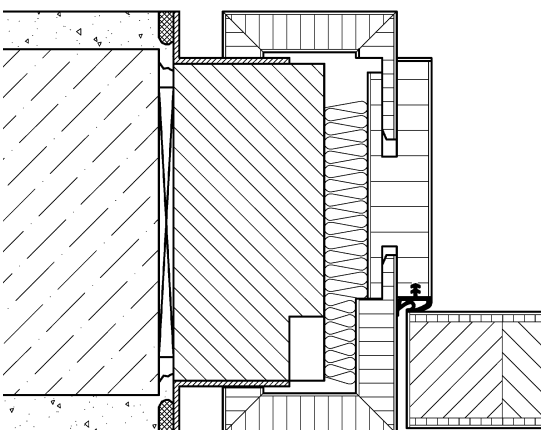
Block-Zarge B60/75 mit Winkelprofil in Massivwand,
